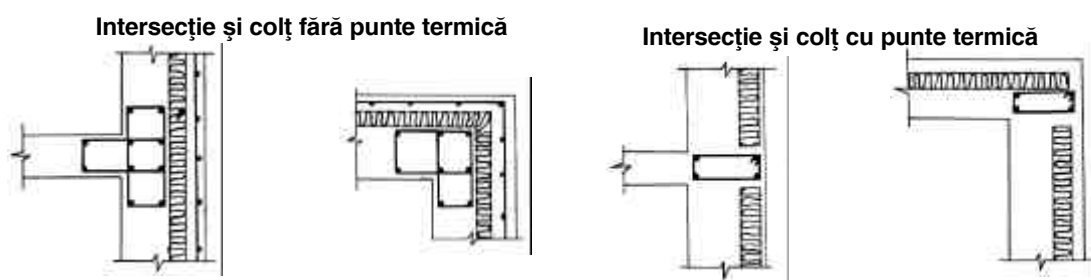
I.2 Armarea pereților din beton armat monolit. Elevație. Secțiuni. Detalii
